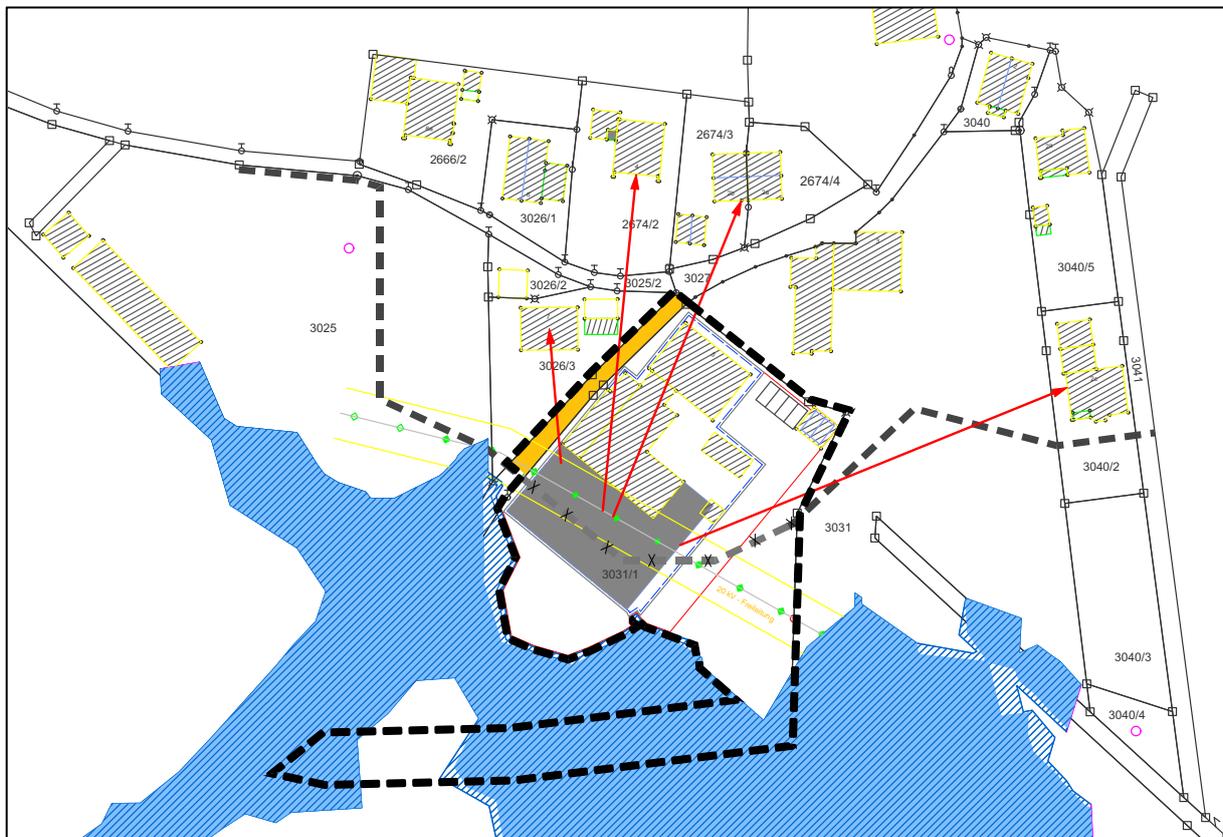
nächstgelegene Wohnbebauung zur neuen Werkshalle
